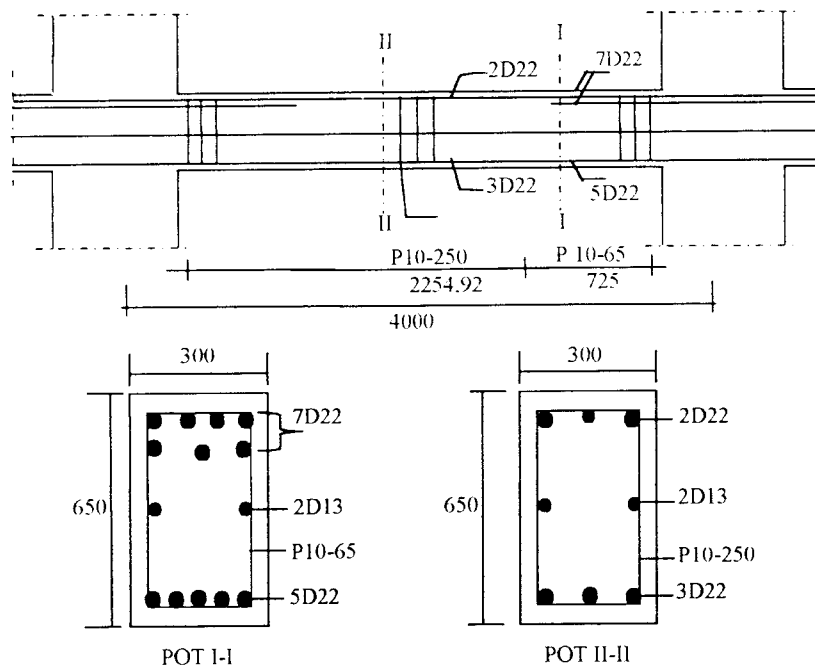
Balok Portal E Bentang 4 m Lantai 4
